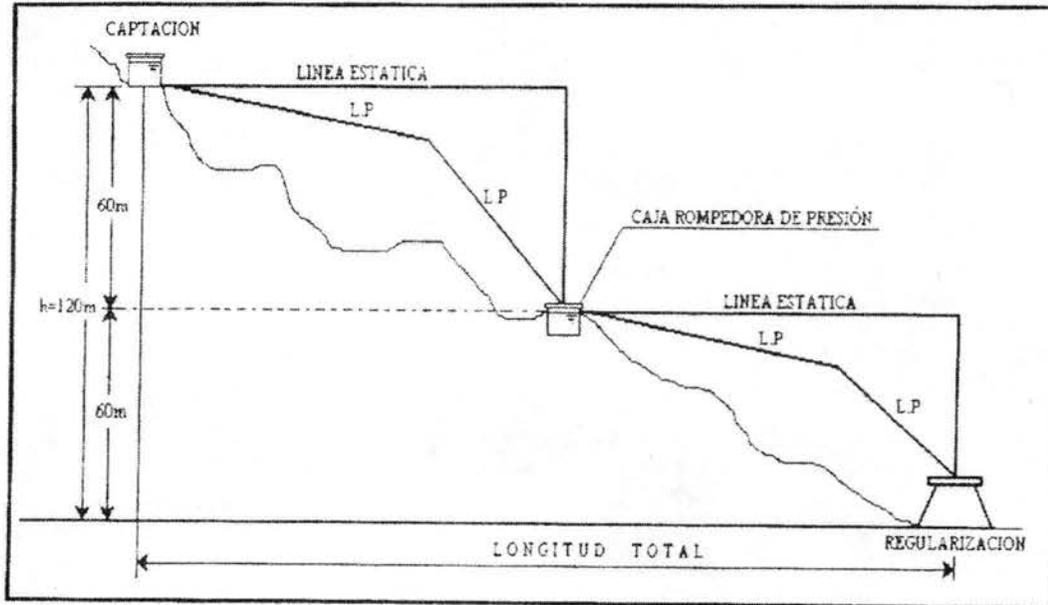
Ubicación de una caja rompedora de presión en una línea de conducción.
